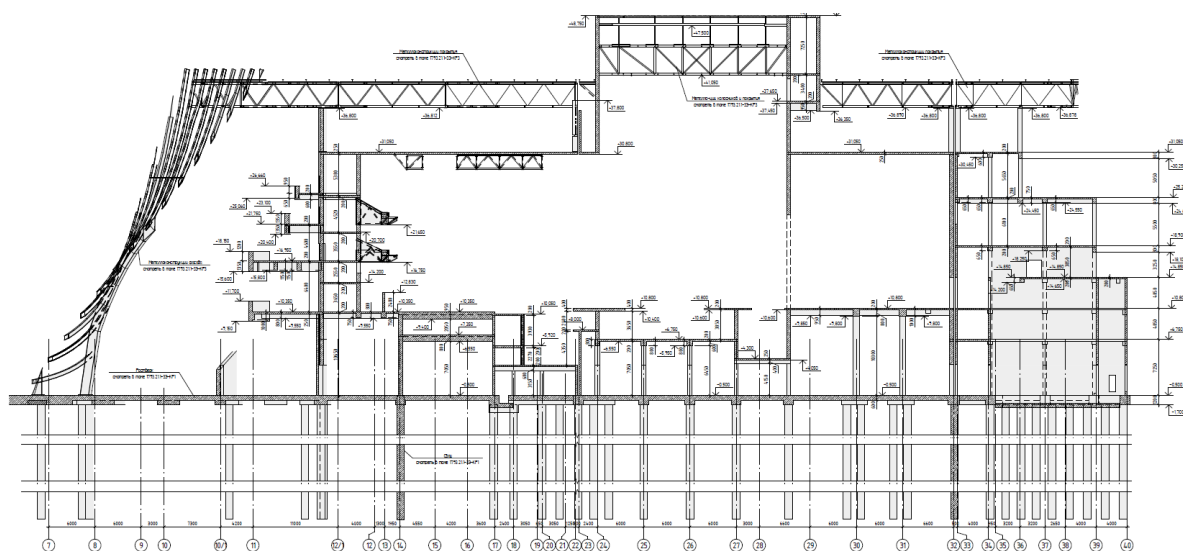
Продольный разрез по зданию Театра оперы и балета
